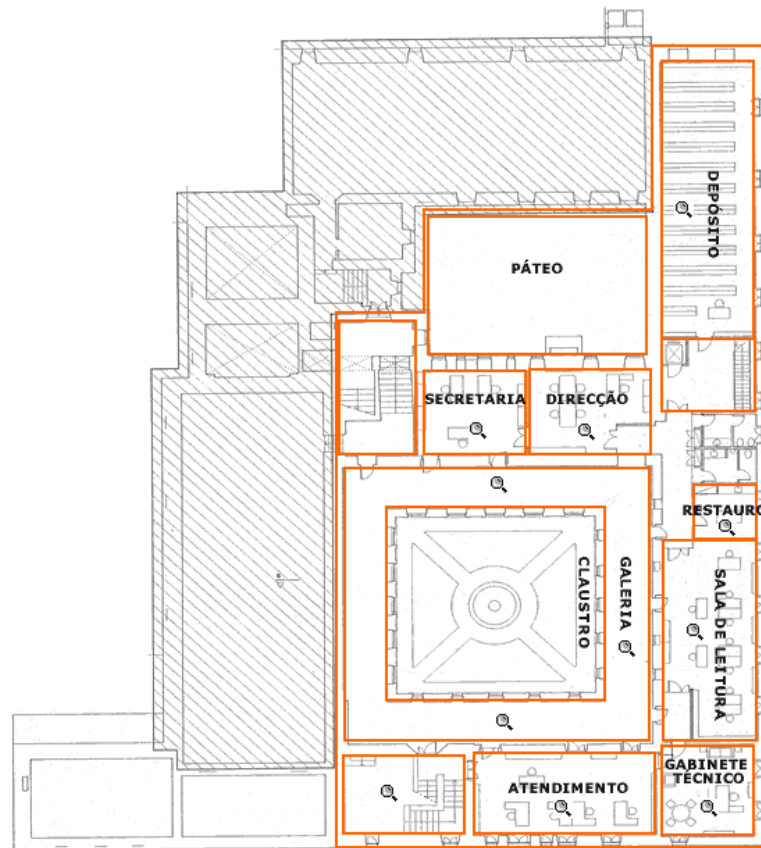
Planta da área ocupada pelo arquivo no piso 1. Fonte: www.adgrd.pt.
